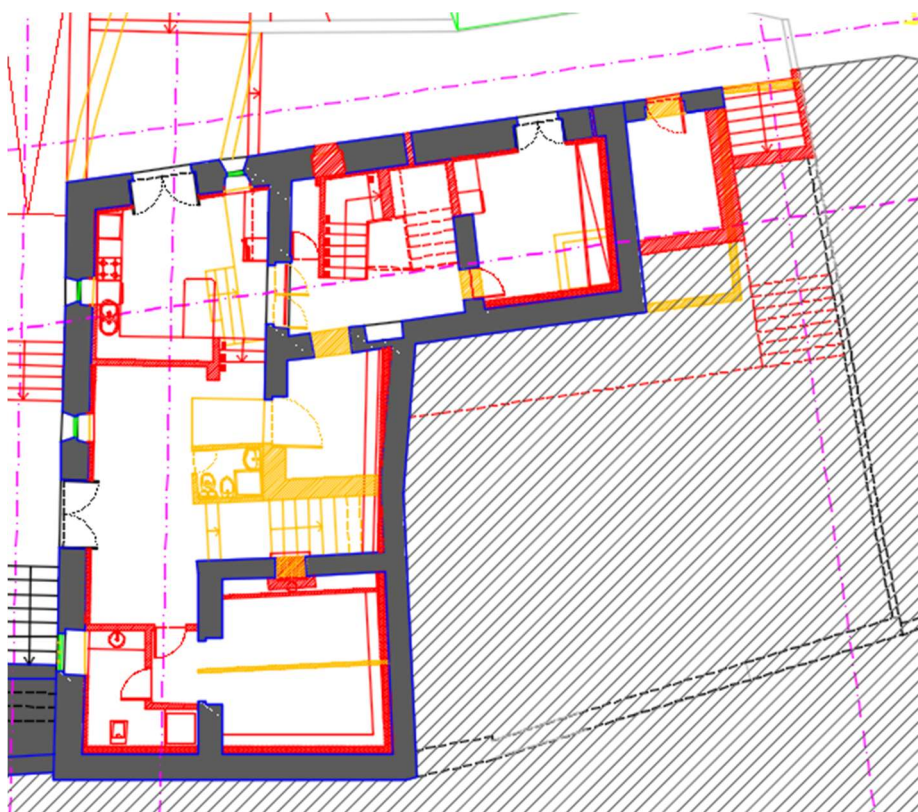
Planta de arquitetura da cave - vermelhos e amarelos (planta sem escala).
